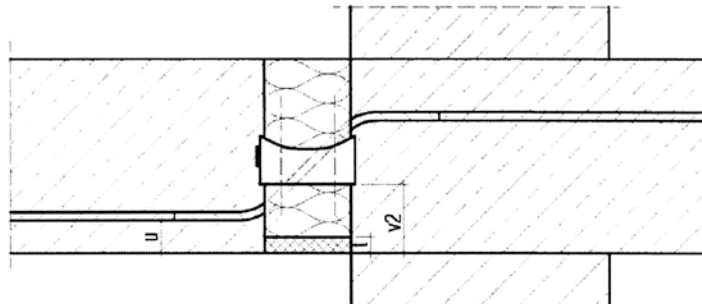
Schöck Isokorb Typ Q (Ausführungsvariante B) gem. Abschnitt 2.1.3
